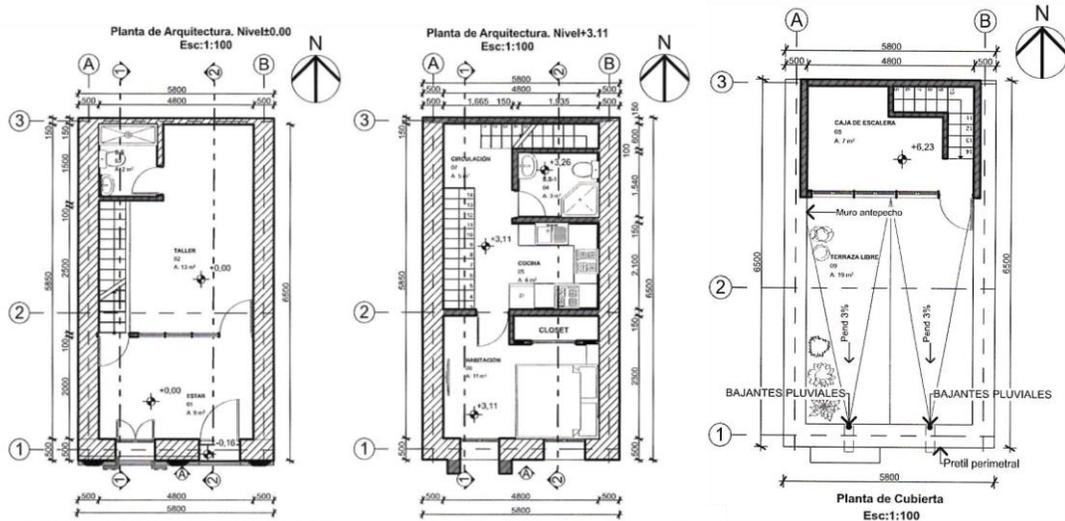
Plans de la maison San Gil Hernandez (source : Diaz, 2019)
